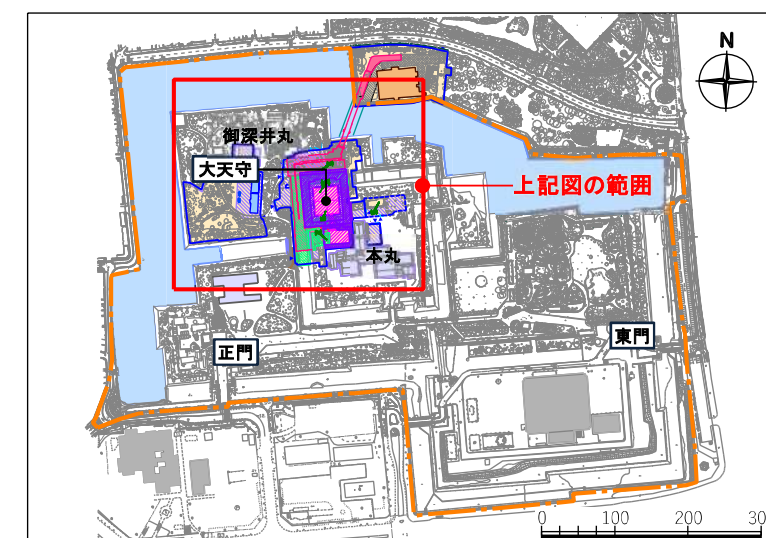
現天守閣解体工事時の平面図(敷地全体)
